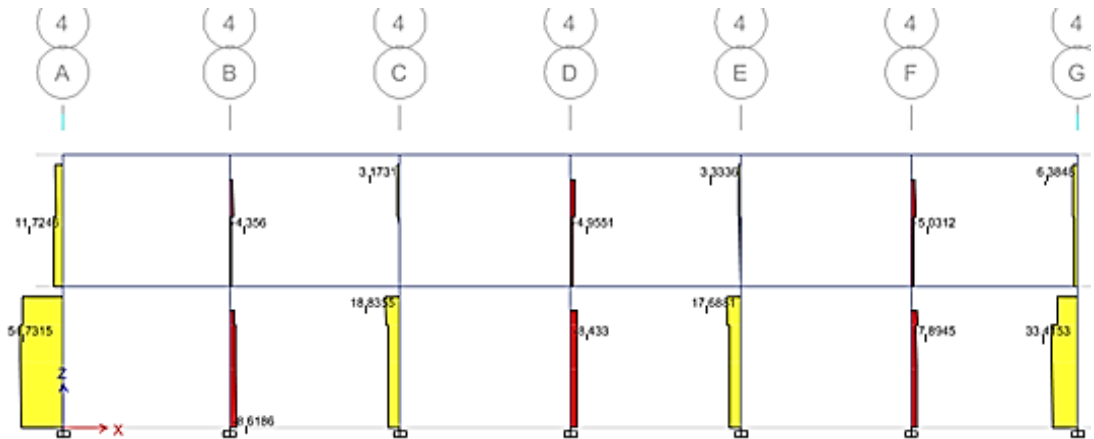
Fuerza axial por envoltorio en dirección del eje 4
